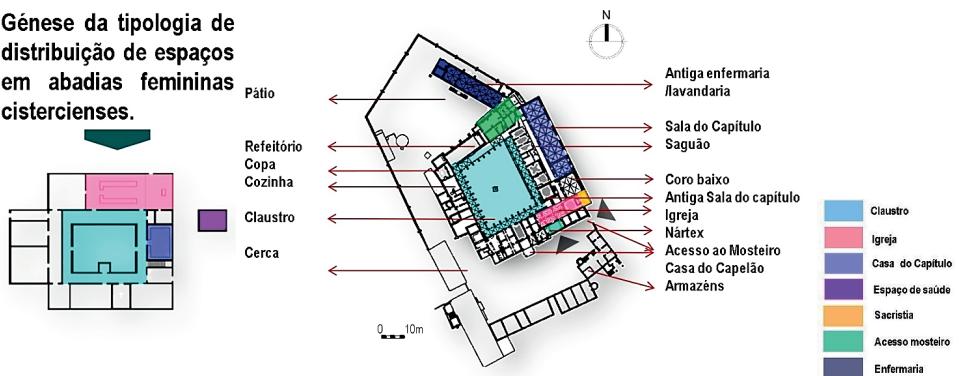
Planta do piso térreo do mosteiro. Fonte: planta desenhada por M. C. Tereno com base em Monumentos.pt.
